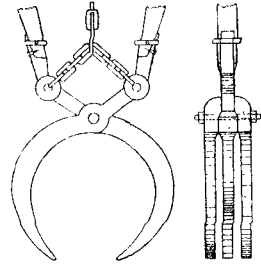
przedstawia kleszcze połączone z drągami zawiasowo. Drągi te wystają ponad wodę i służą do kierowania kleszczy od ręki; dla tego też przyrząd ten potrzebuje tylko jednego łańcucha.
